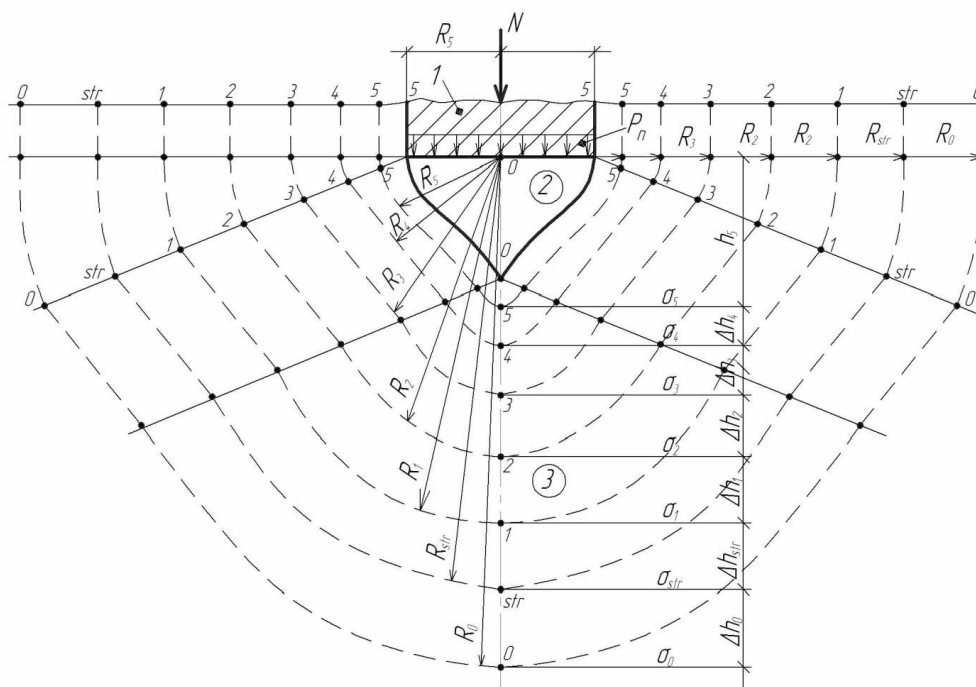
Схема развития зон предельных напряженно-деформированных состояний грунта под фундаментом – 1; 2 – в объеме уплотненного ядра; 3 – в его основании
